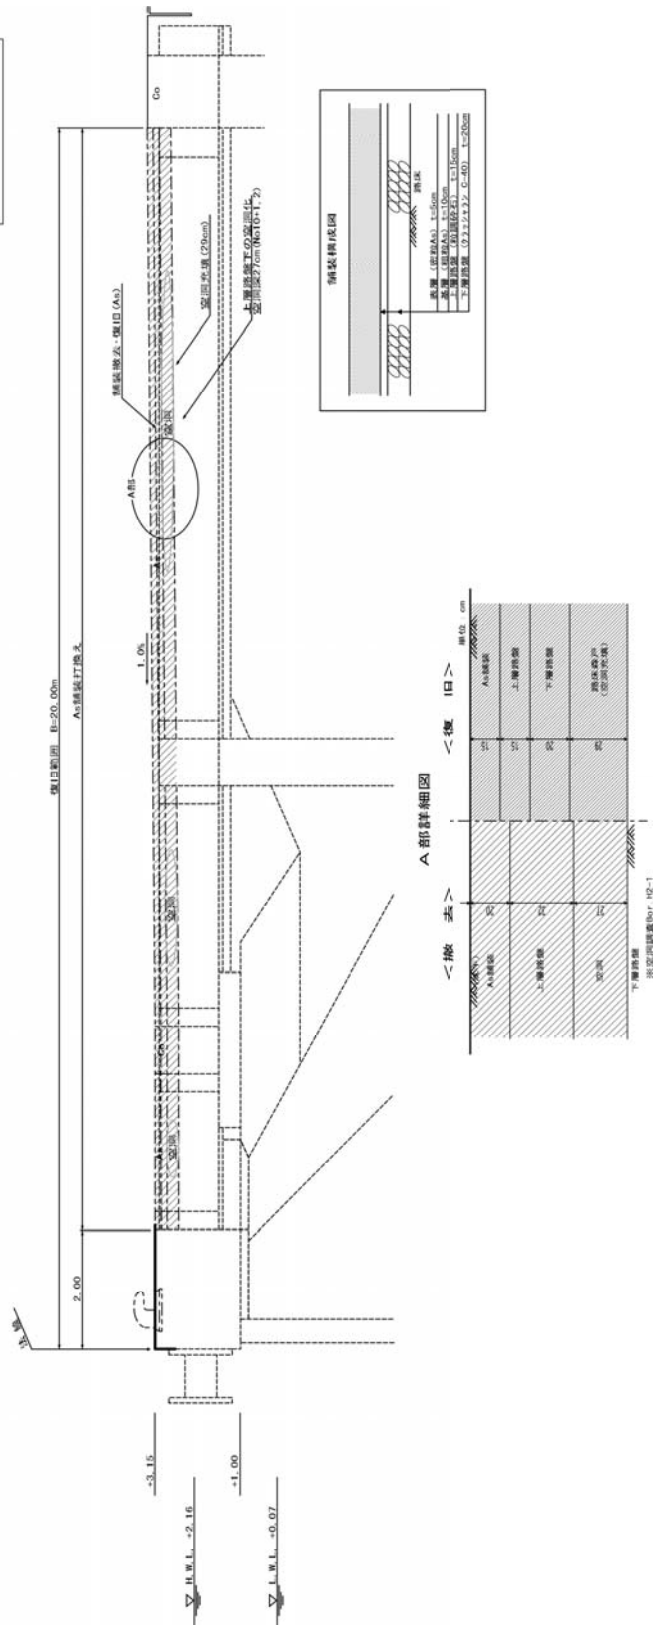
(b) 箱崎埠頭-10m岸壁の被災・復旧標準断面図
